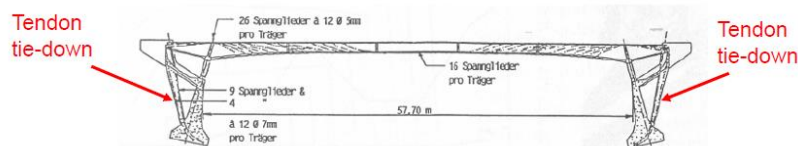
Esquema estructural del puente. Rotura del tirante de empotramiento en estribo [1].
